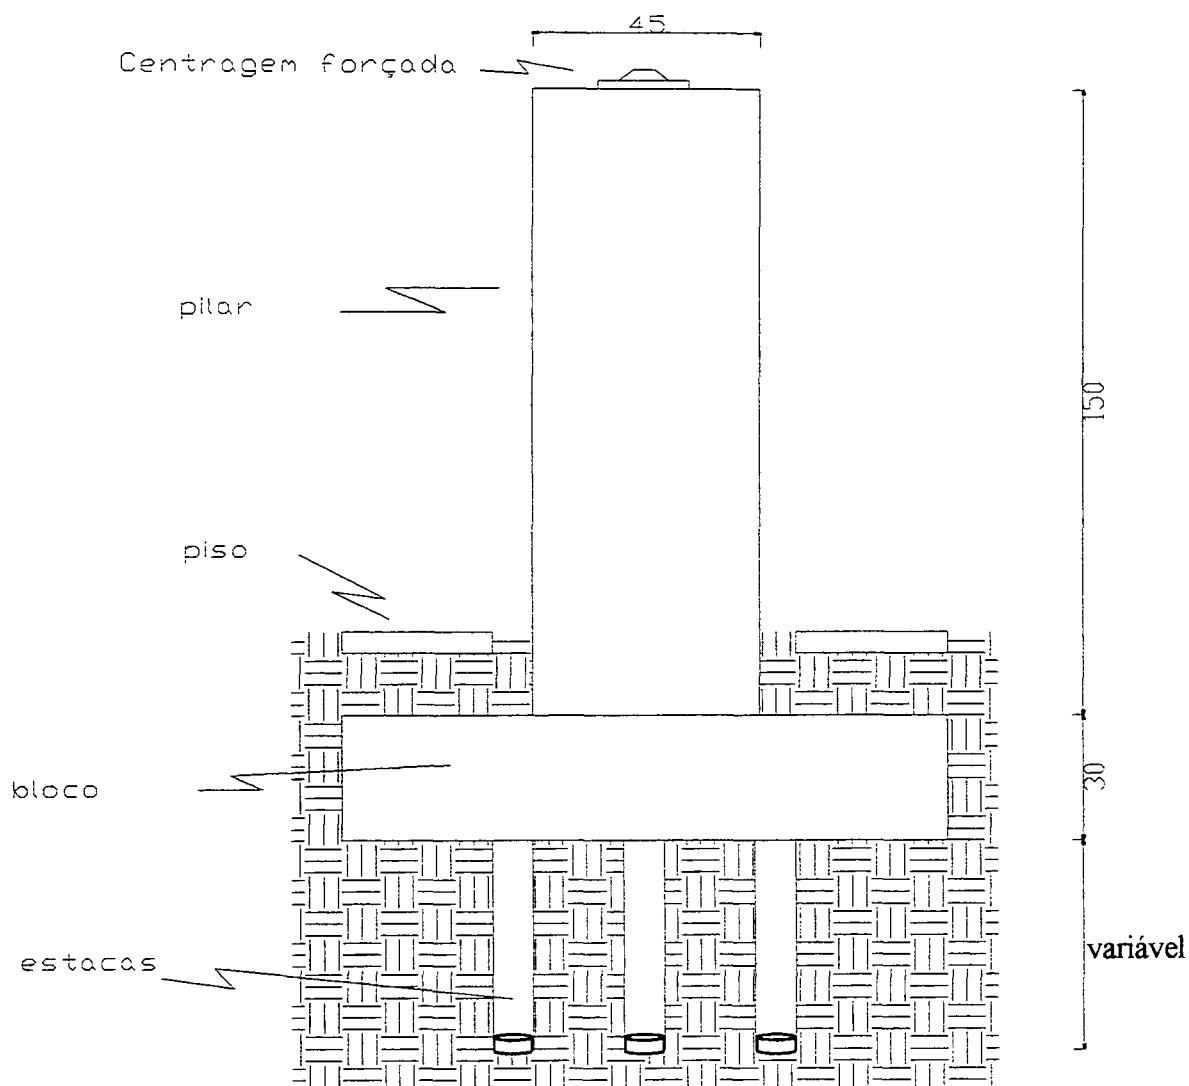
Esquema estrutural de um pilar da base de aferição da UFPr (dimensões em centímetros).
